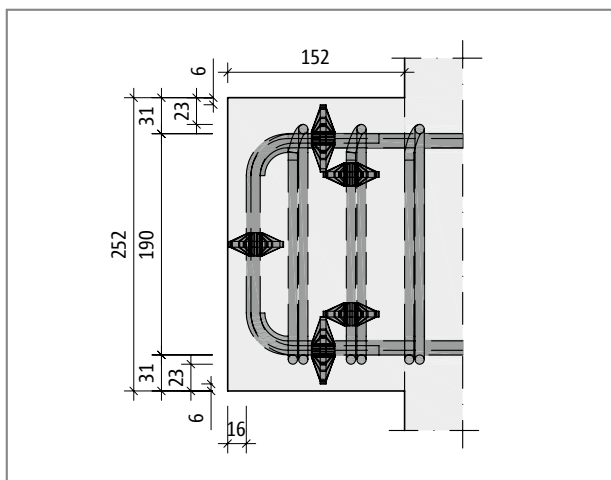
Schöck Tronsole® tipo Z, pianta di una mensola in calcestruzzo con elemento portante incassato
